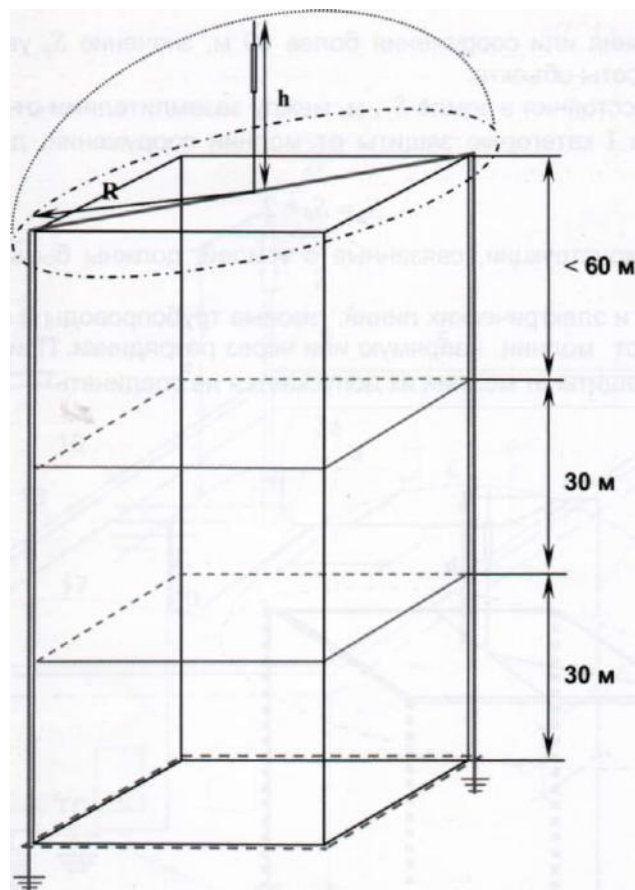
Молниезащита здания из железобетонных конструкций выше 60 м
